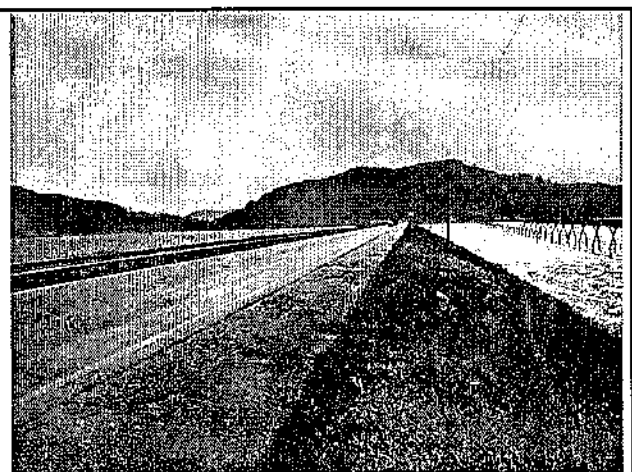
vista do aterro em direção ao Canal e Ponta da Laranjeira (ponte prevista ao lado direito).
